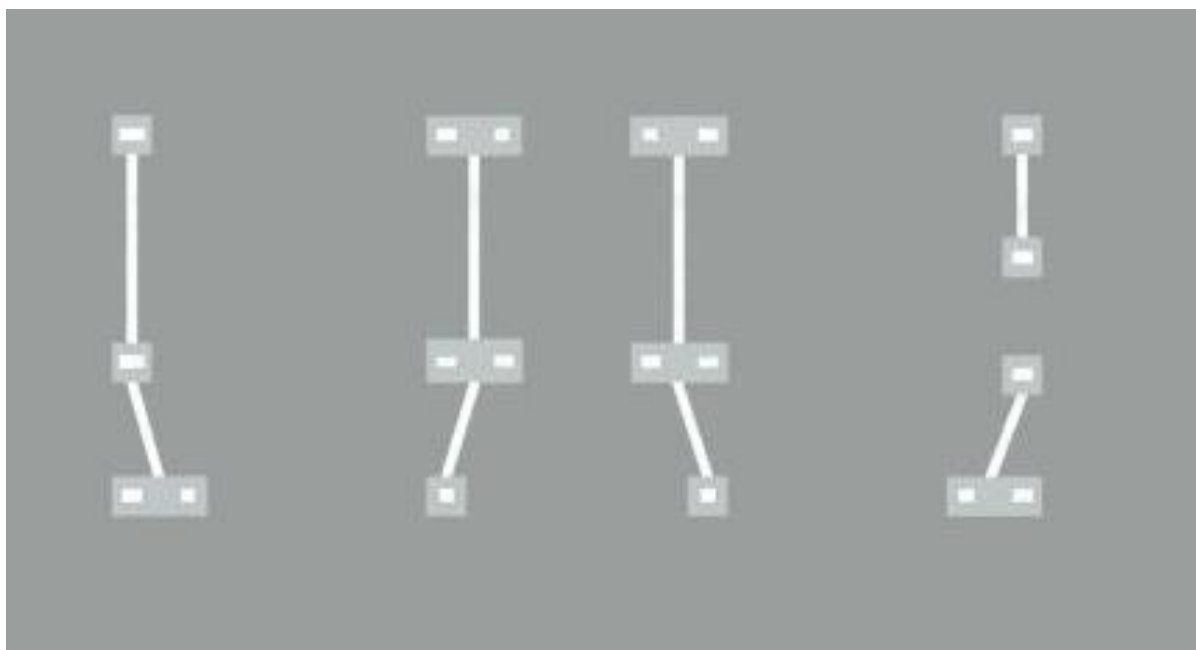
Vista em planta dos blocos de fundação e vigas-alavanca
